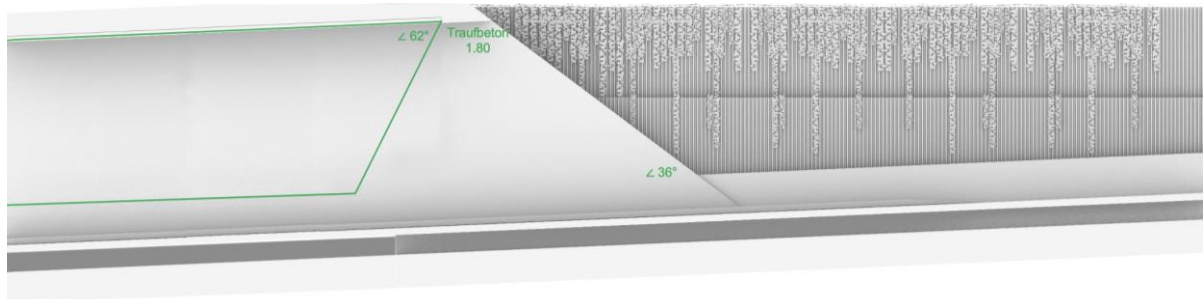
Abwicklung mit Übergang Tunnelwand (Lärmschutzelemente) / Portalbereich (Sichtbeton) / Stützmauer (Lavabeton, Begrünung)
